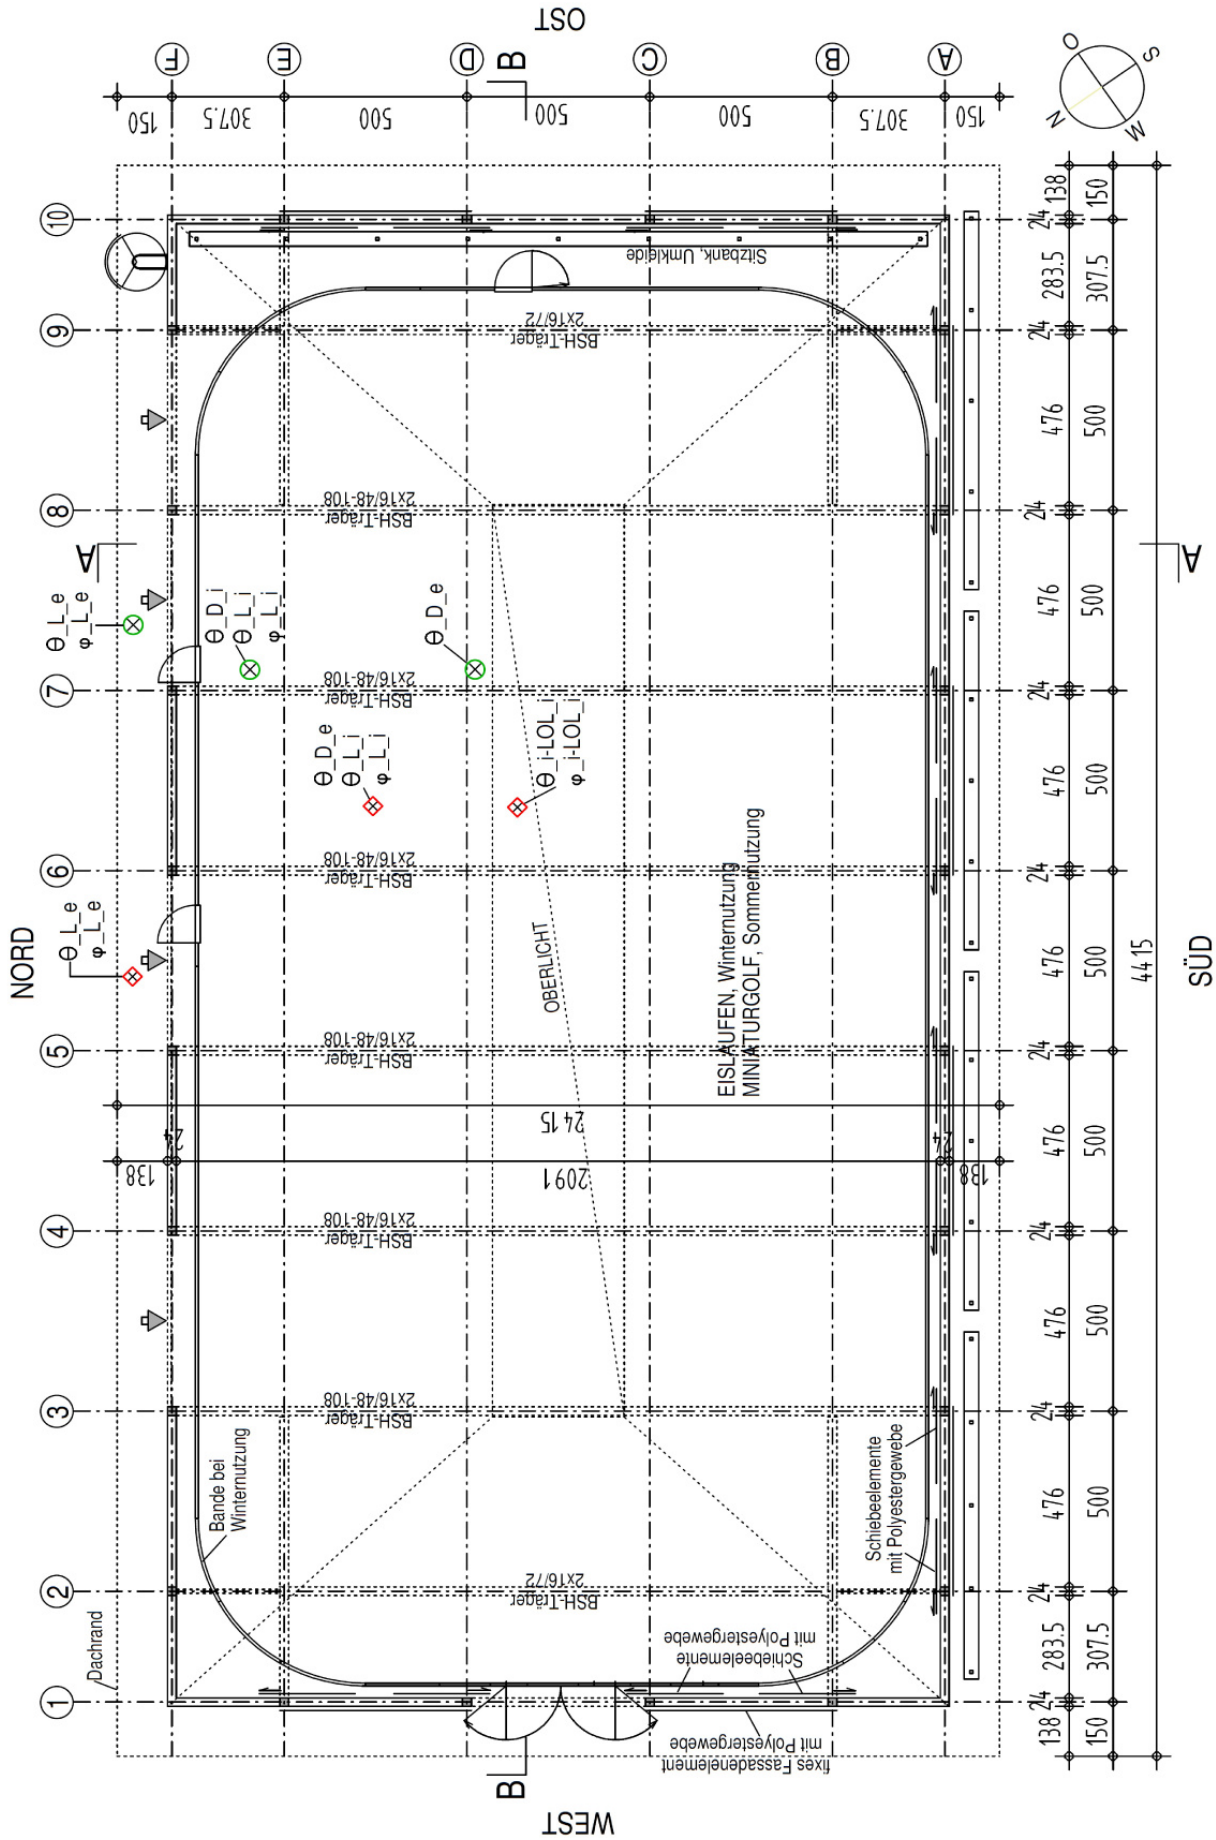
Grundriss der Eishalle Bergheim; Lage der Messpunkte; überarbeitet nach mfgarchitekten [6]; Legende siehe Abb. 3-4
